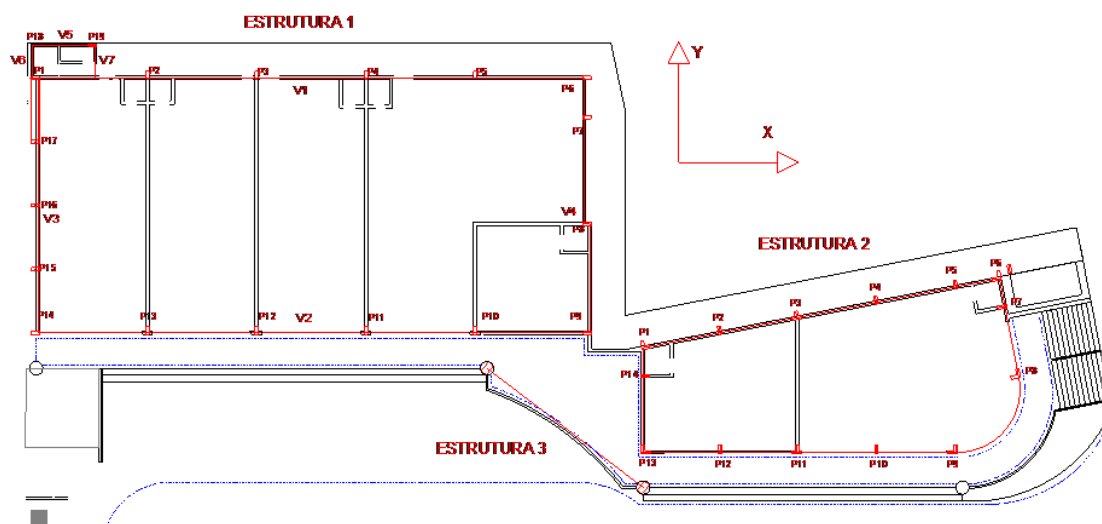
Croqui em planta da estrutura, com alvenaria
